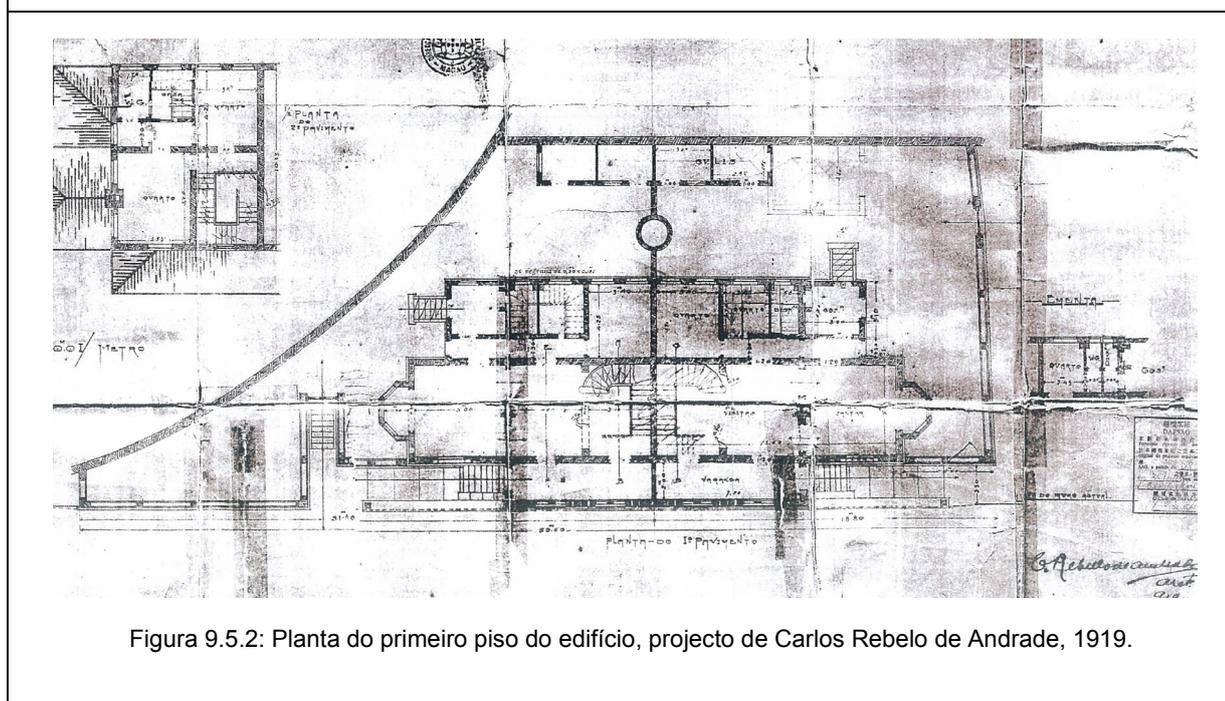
Planta do primeiro piso do edifício, projecto de Carlos Rebelo de Andrade, 1919.
